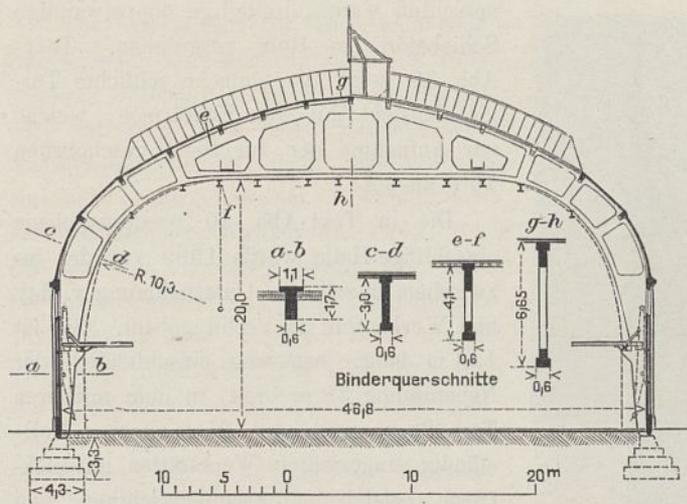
Zweischiffige Bauhalle in Eisenbeton.
